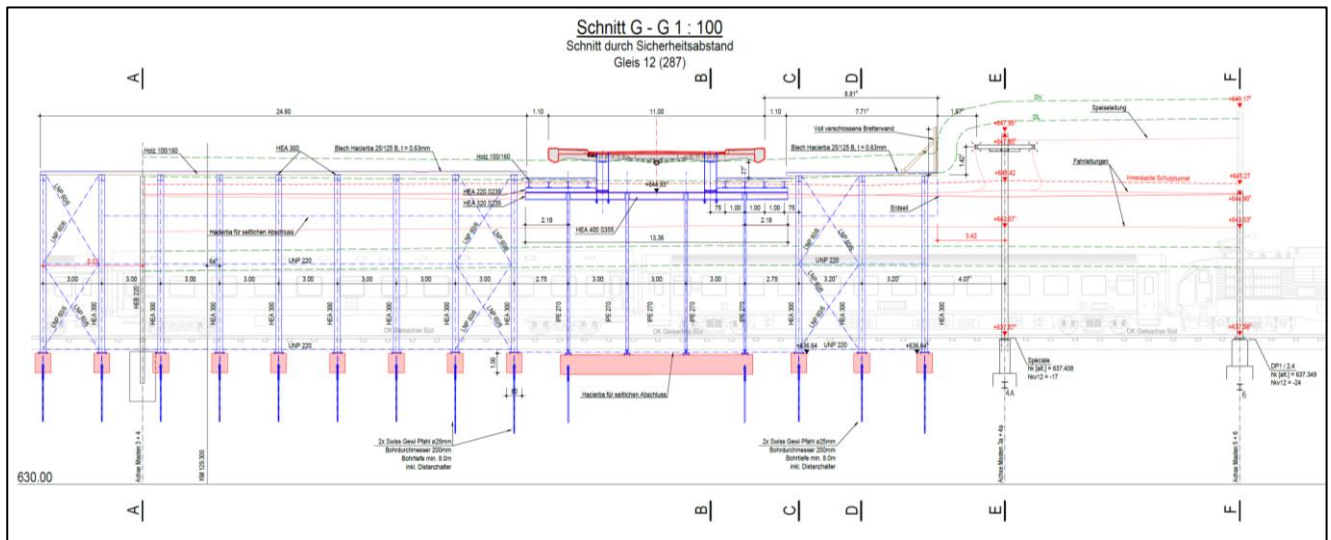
Schutztunnel im Querungsbereich best. Überführung Turtig mit SBB-Trasse, Längsschnitt
